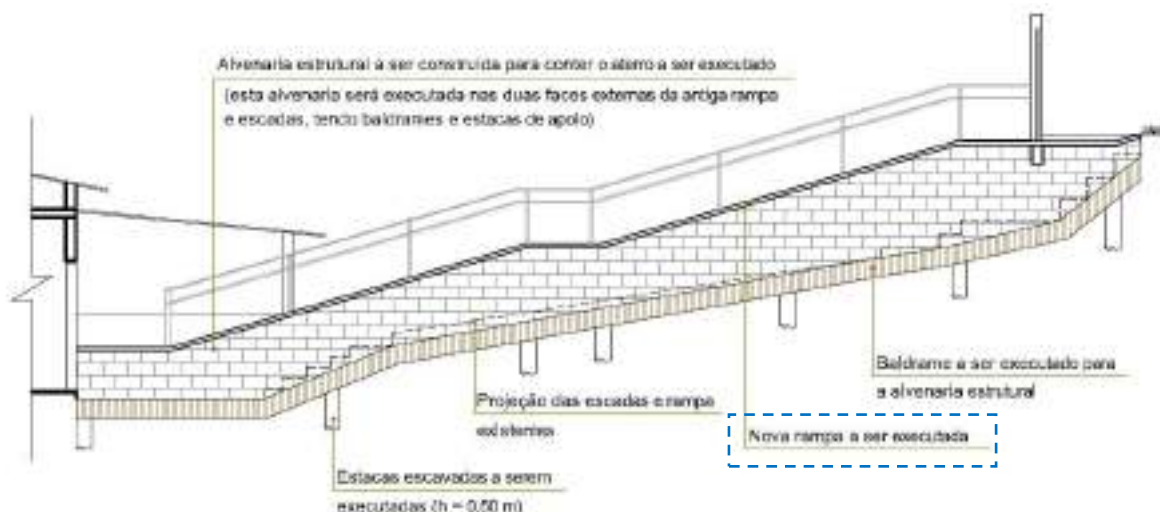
Vista lateral do esquema de construção da nova rampa.
